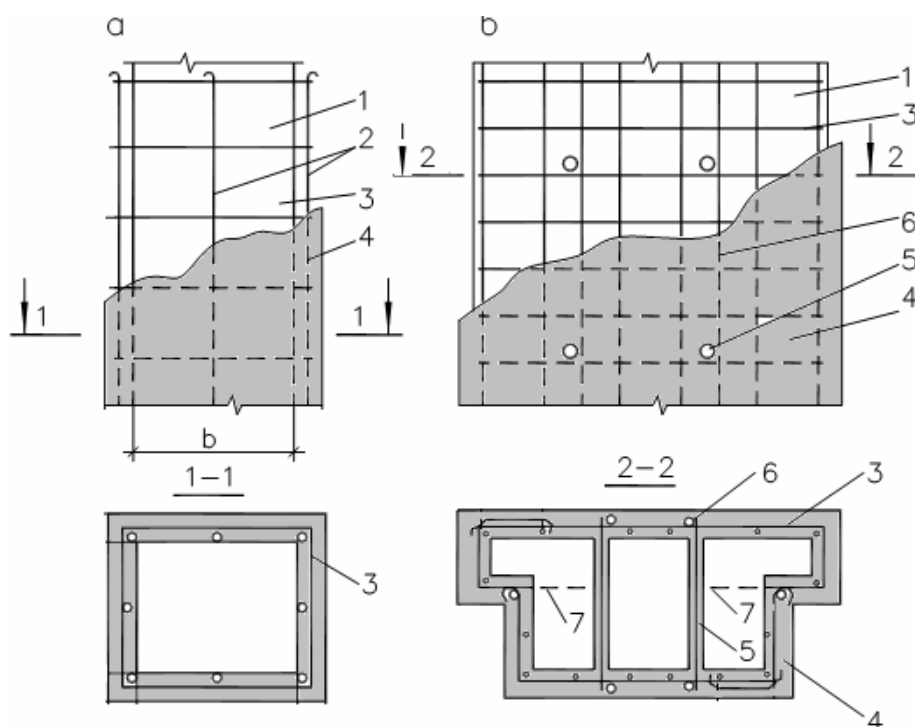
Усиление железобетонной обоймой: *a* – столбов, *б* – простенков: 1 – усиливаемая конструкция, 2 – продольная арматура, 3 – поперечная арматура, 4 – бетон, 5 – дополнительные поперечные связи, 6 – продольная арматура, 7 – анкеры
